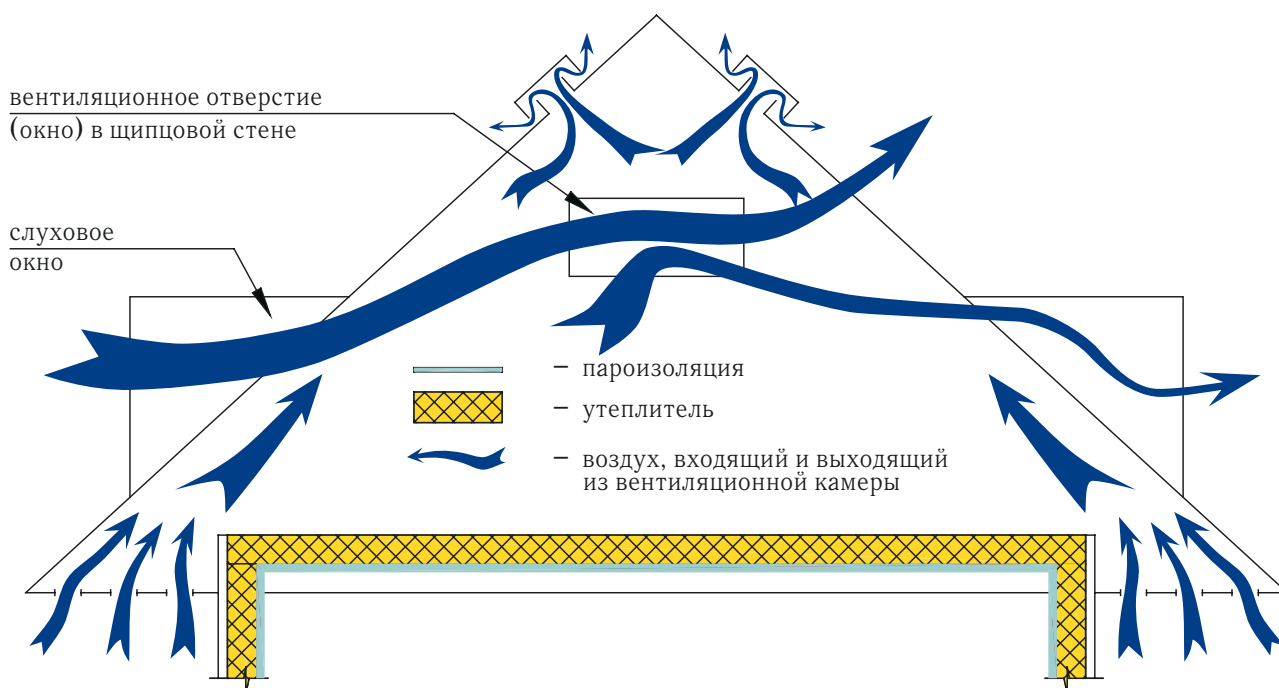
Схема утепления, пароизоляции и вентиляции нежилого чердачного помещения
